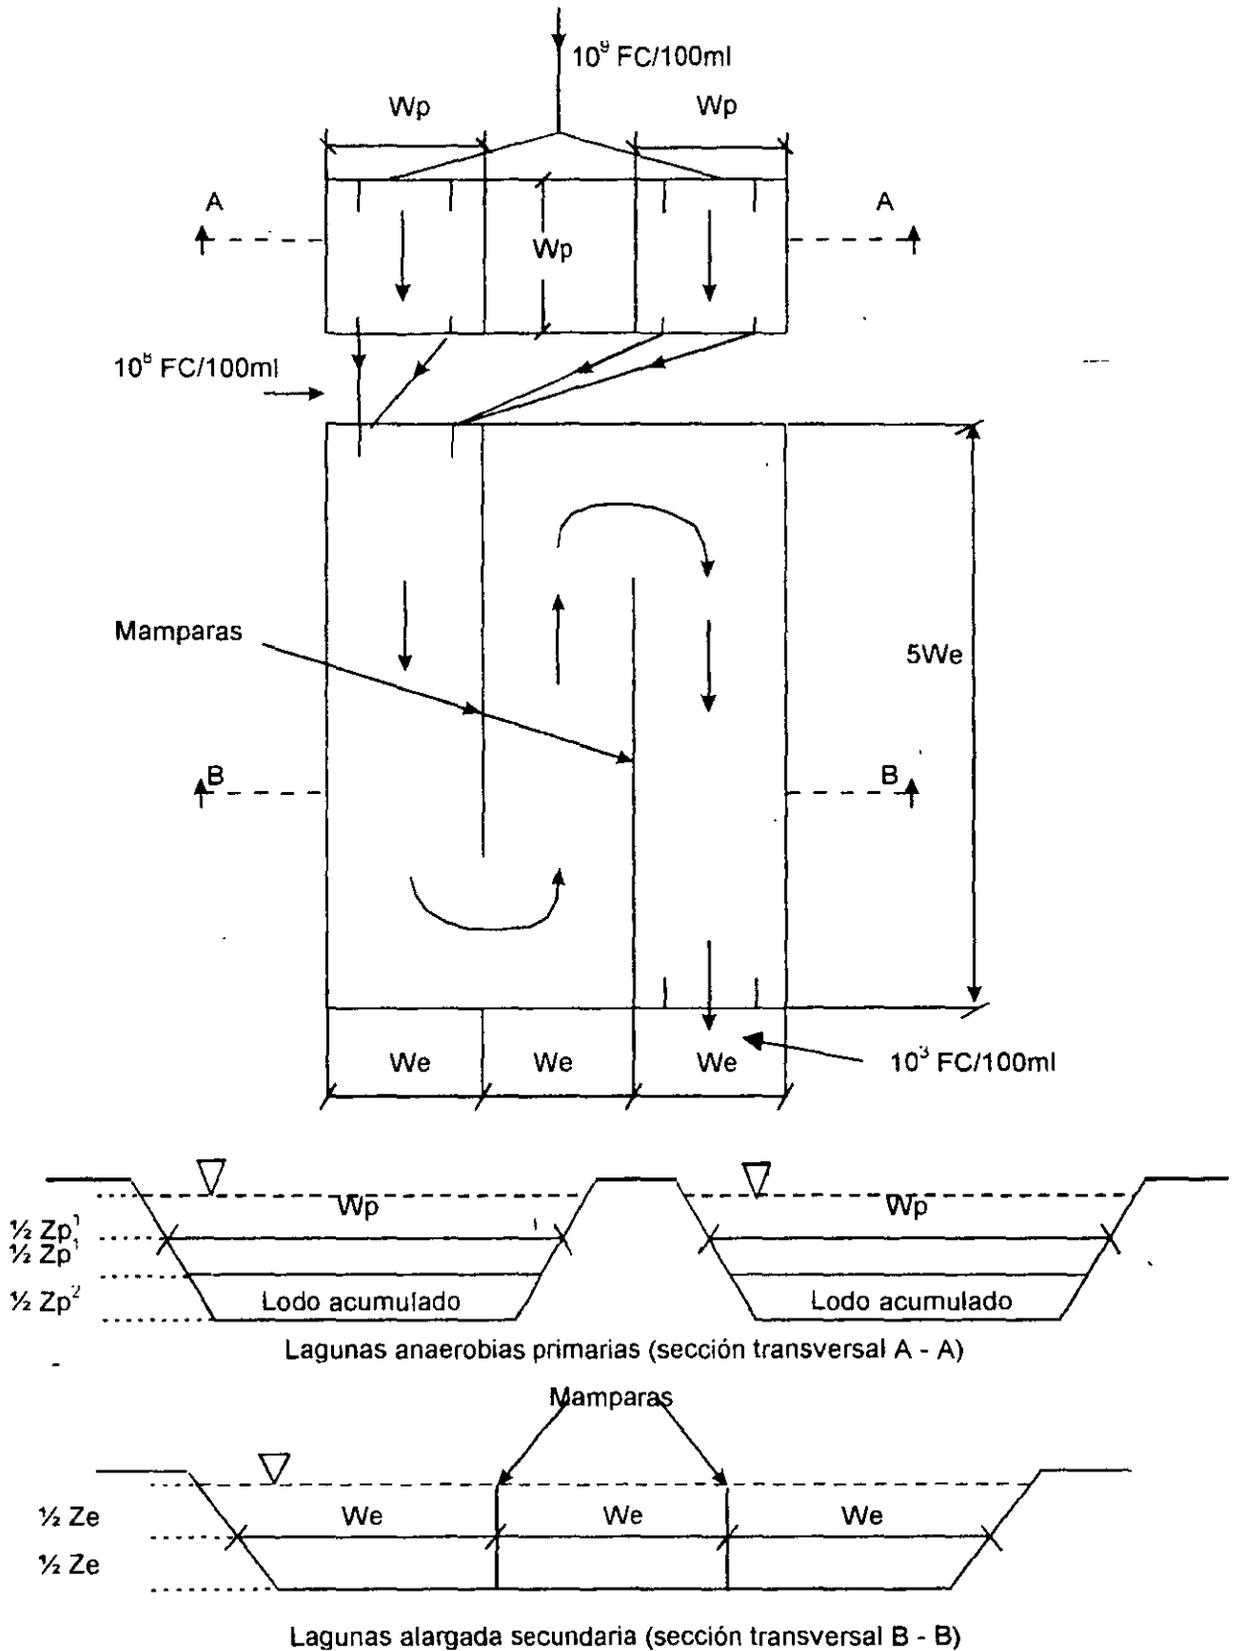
Esquema para el diseño de lagunas anaerobias primarias y lagunas alargadas secundarias en terrenos planos o ligeramente inclinados
